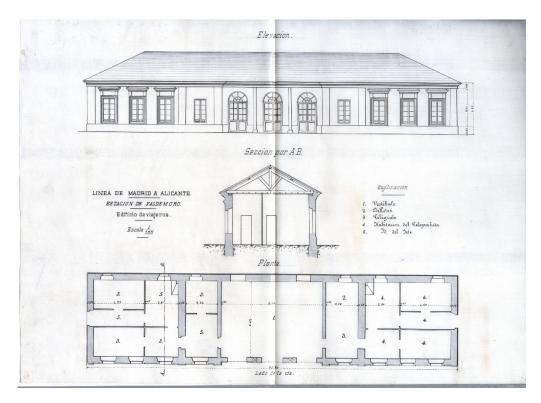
Planta y alzado del antiguo edificio de viajeros de la estación de Valdemoro (1879). AHF, signatura: B-47-2-6.
